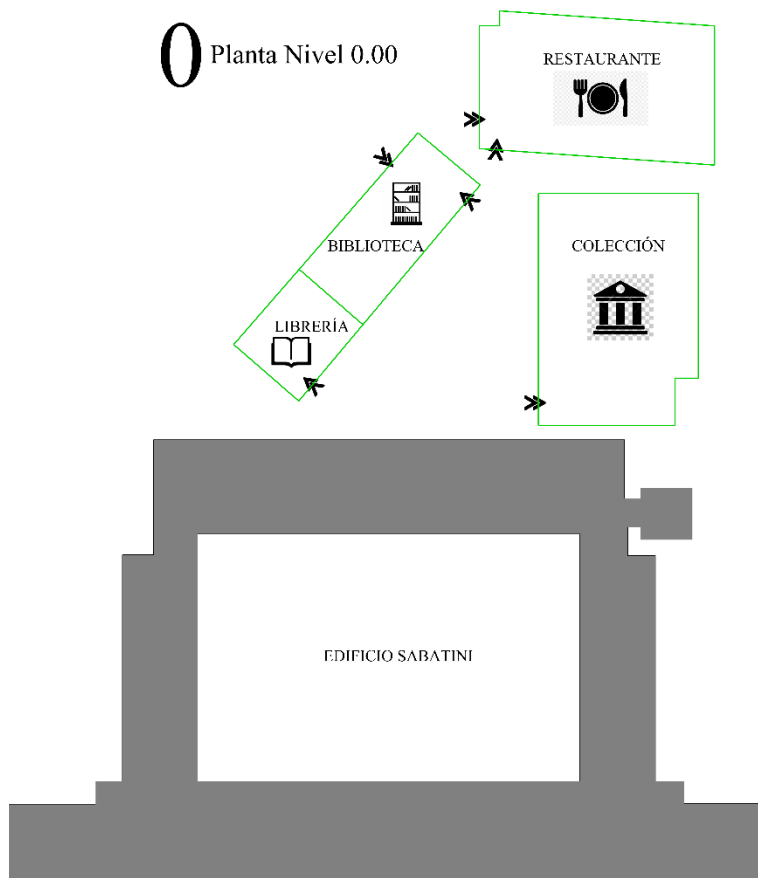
Planta Nivel 1, Museo Reina Sofía - Fuente: Elaboración Propia
